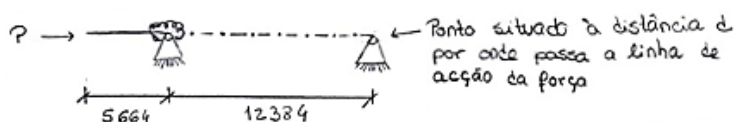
Modelo estrutural constituído uma viga contínua com um tramo em consola, e com um apoio modelado por uma mola rotacional
